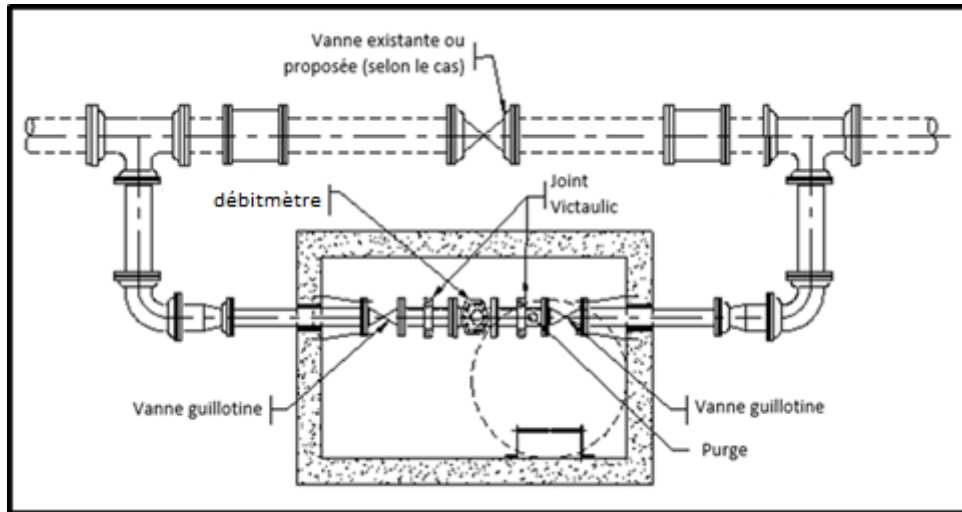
Installation d'un débitmètre sur une conduite en dérivation
